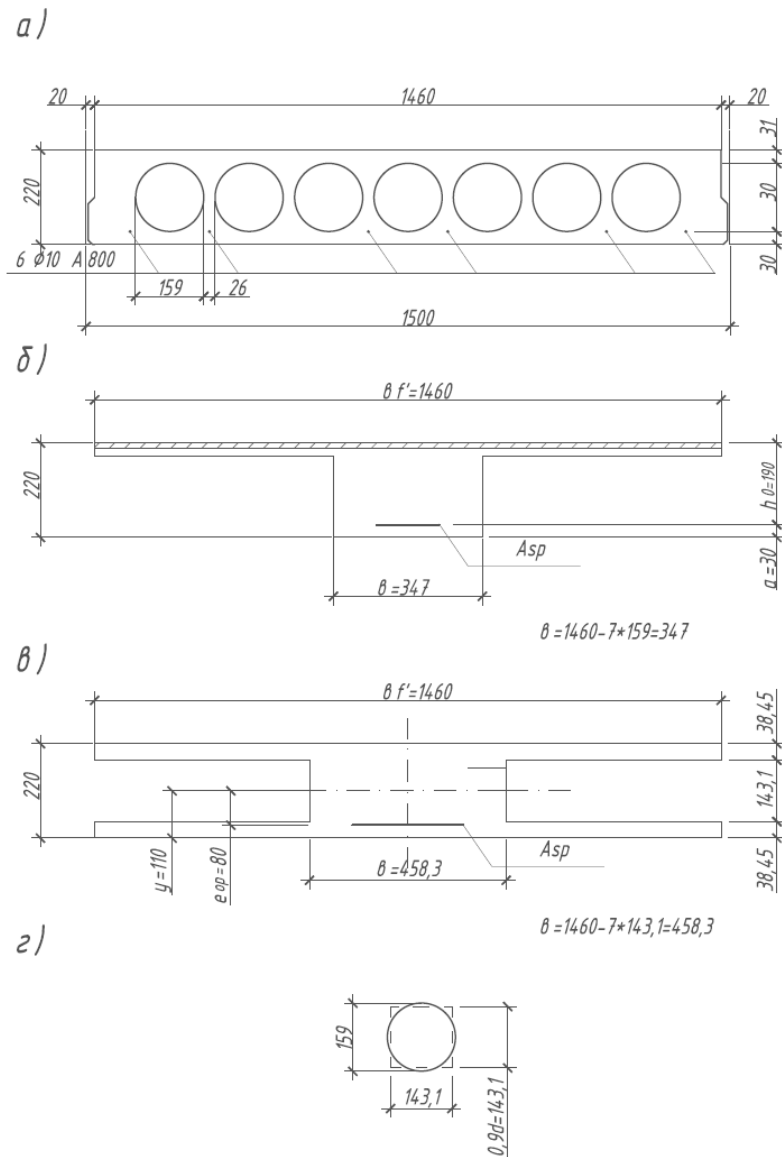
Поперечные сечения плиты с круглыми пустотами: а- основные размеры; б- к расчету по прочности; в- к расчету по второй группе предельных состояний; г- к расчету эквивалентного сечения.
